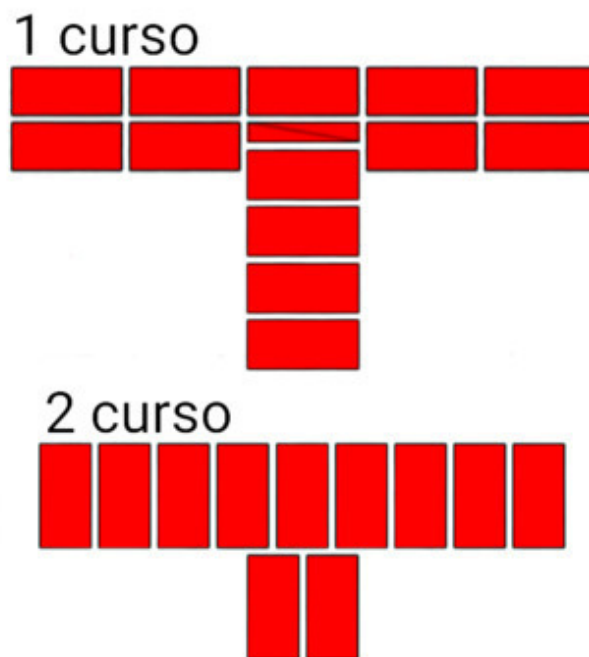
A ordem de colocar o tijolo nas paredes adjacentes. A espessura das paredes é de 1 e 1 tijolo.
